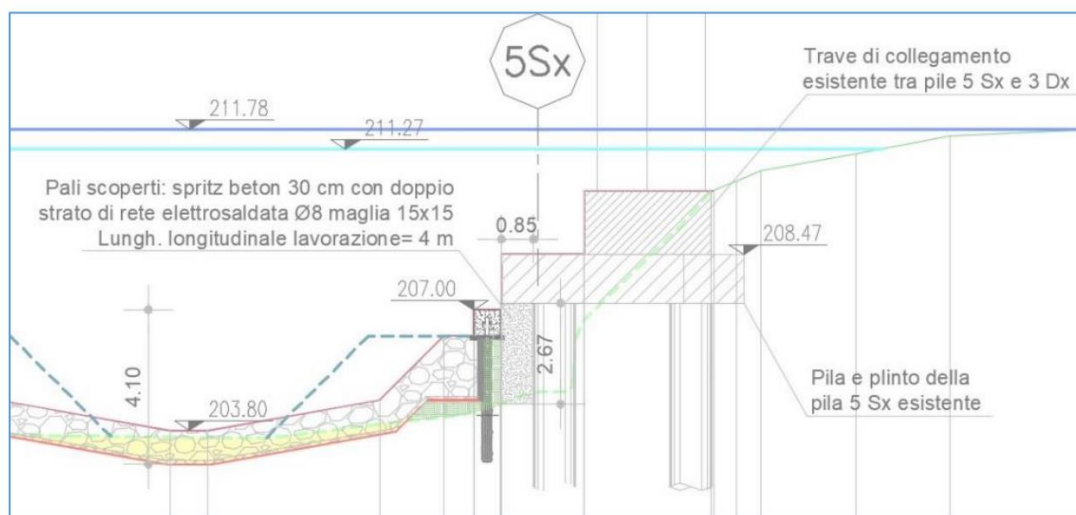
Intervento in corrispondenza delle pile in Dx idraulica nuovo progetto
